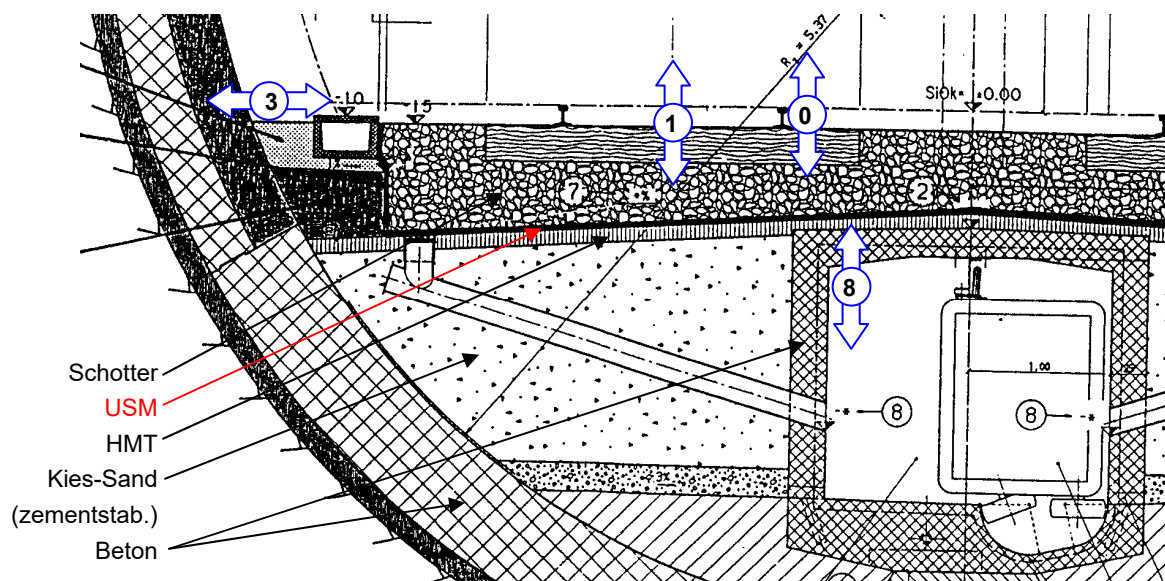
Tunnelquerschnitt: Ober- und Unterbau, Messpunkte mit den relevanten Schwingrichtungen
